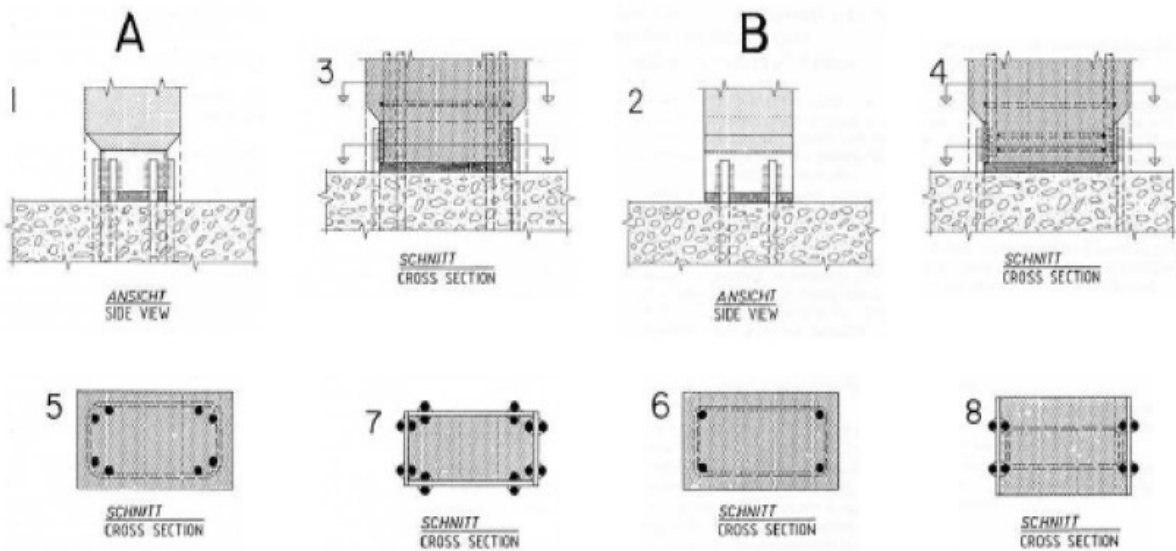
Ligação por soldagem a chapa e barras de aço (Stupré, 1981)
